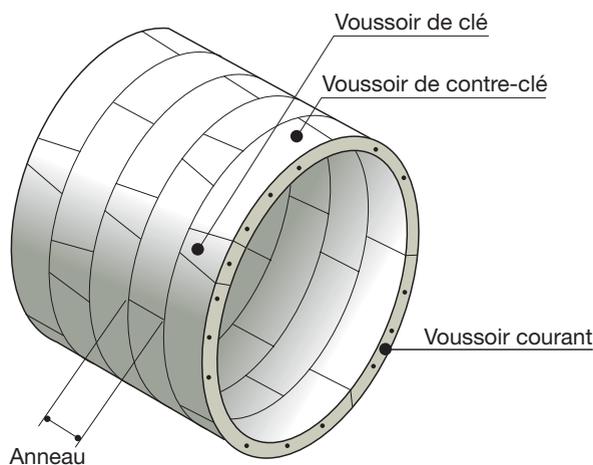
Schéma de principe d'assemblage de voussoirs préfabriqués en béton armé
